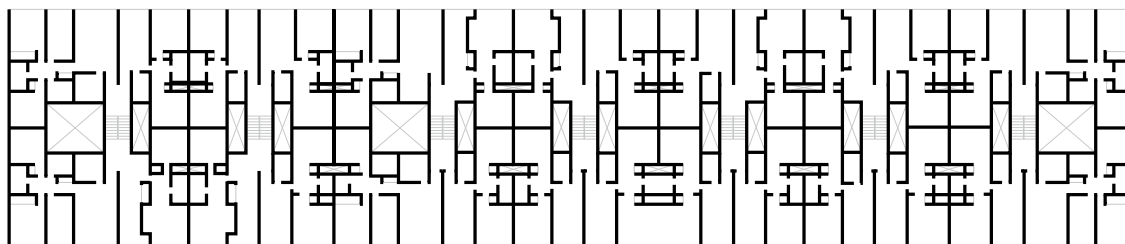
Planta pavimento-tipo do edifício residencial tipologia A.
